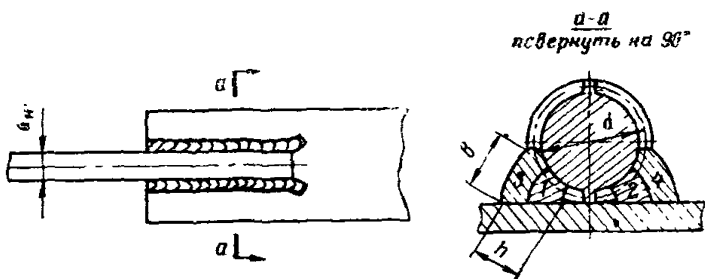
Конструкция нахлесточных соединений стержней с плоскими элементами проката и схема измерения размеров сварных фланговых швов
